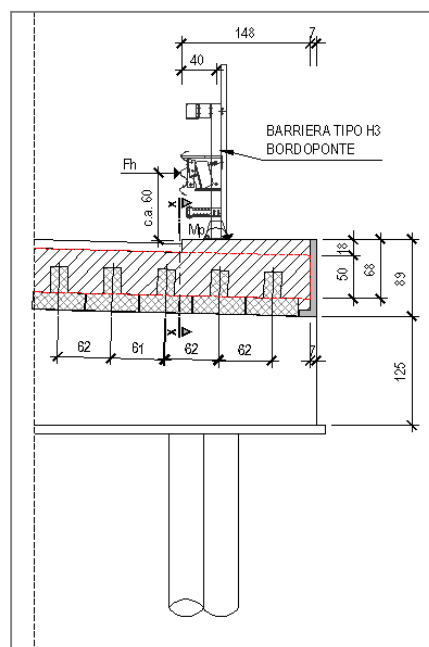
Schema dell'azione d'urto contro la barriera.
